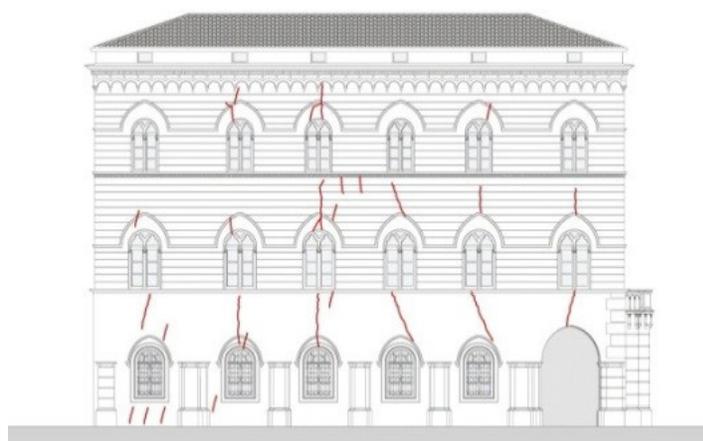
Esquema de fisuras reales en las caras sur del edificio
